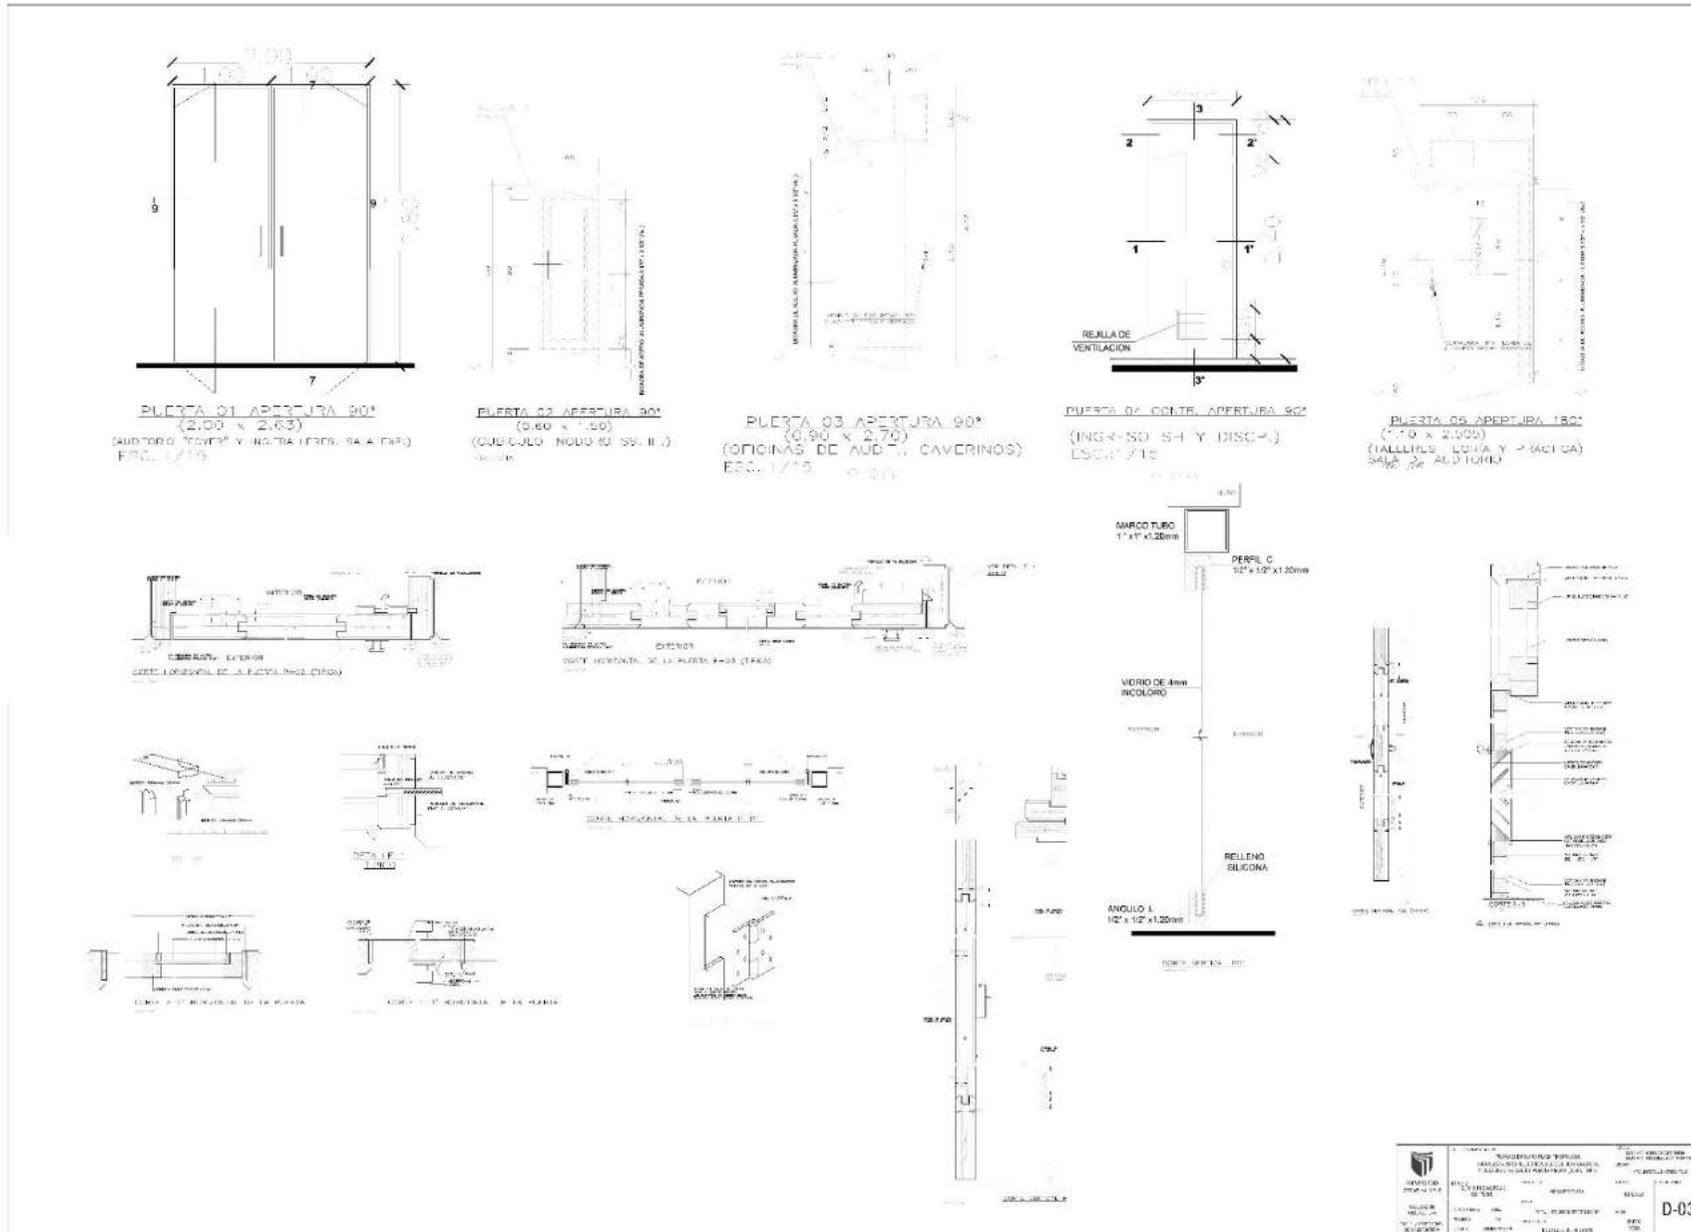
Detalles arquitectónicos – zona cultural. Elaboración propia.
